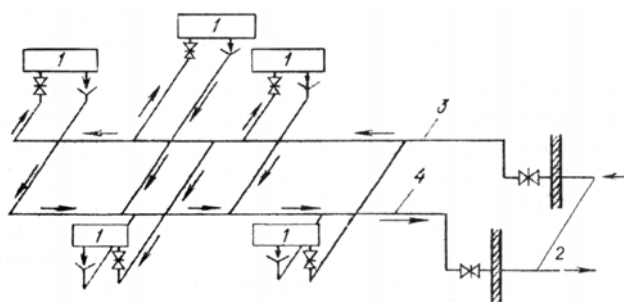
Схема циркуляционных сетей производственных водопроводов:
